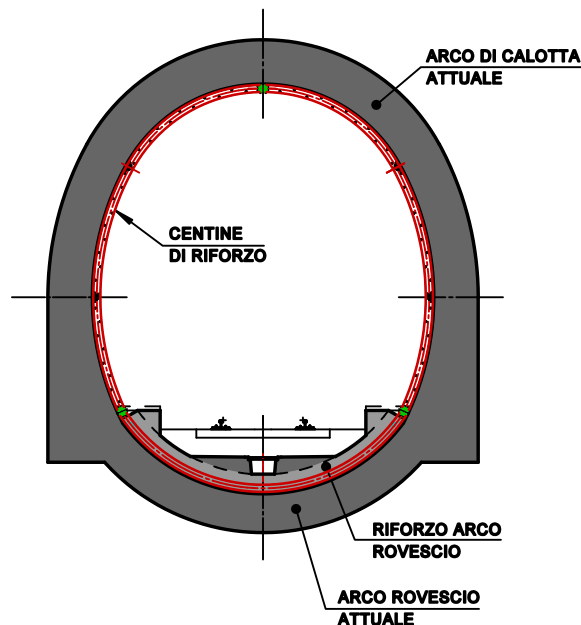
7: Sezione tipo con interventi di rinforzo in progetto
